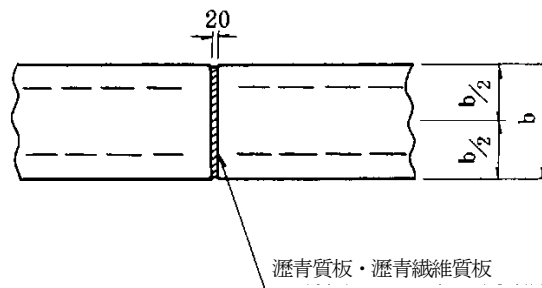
III-35 膨張目地の構造(鉄筋コンクリート擁壁)
